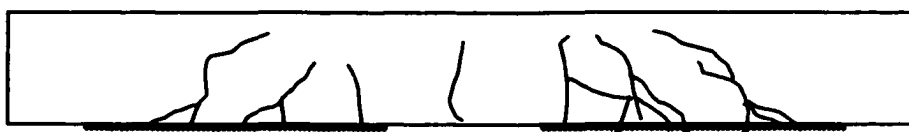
Réseau de fissuration à l'ultime des poutres renforcées de Replark 20
